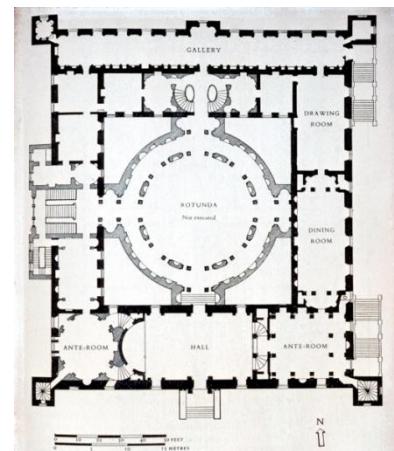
Sion House, Londres, 1760, Robert Adam (hall circular não construído)
